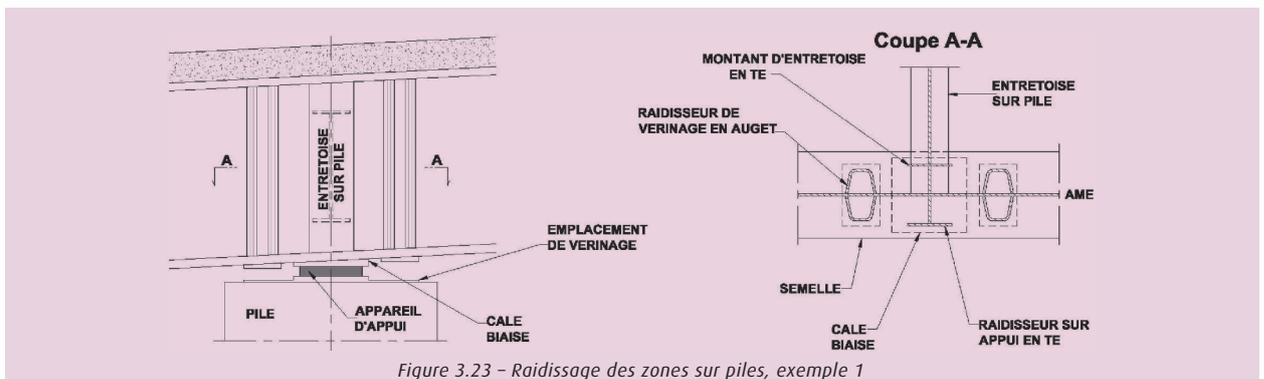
Raidissage des zones sur piles, exemple 1
